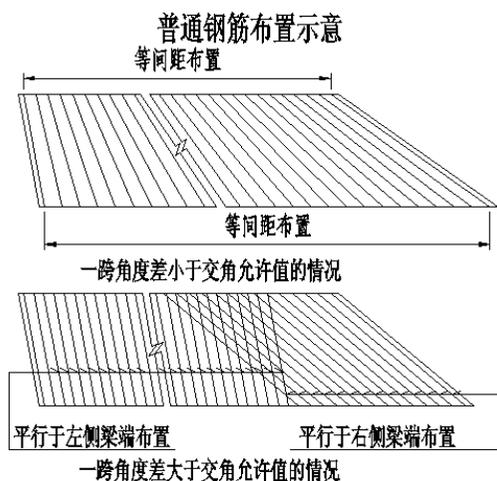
箱梁钢筋-横向钢筋布置-按横向角度差调整
